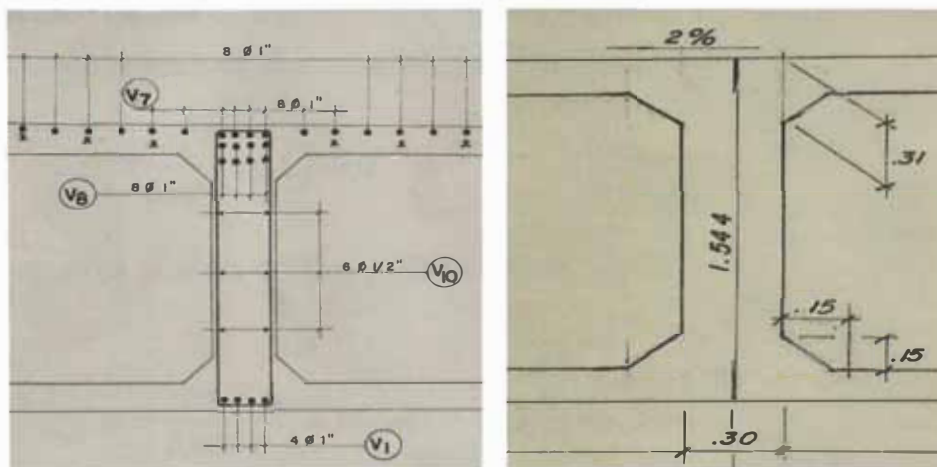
Vista de la sección de viga interior con refuerzo para el momento negativo.
